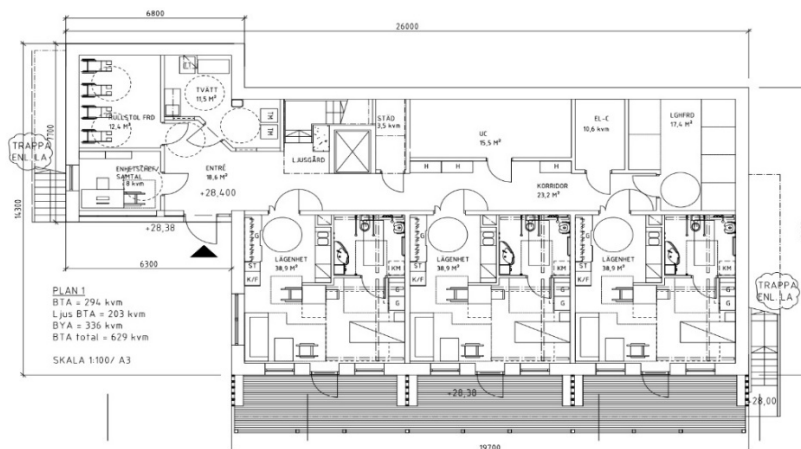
LSS-boende, plan 1. Upprättad 2022-03-16, reviderad 2022-05-13
